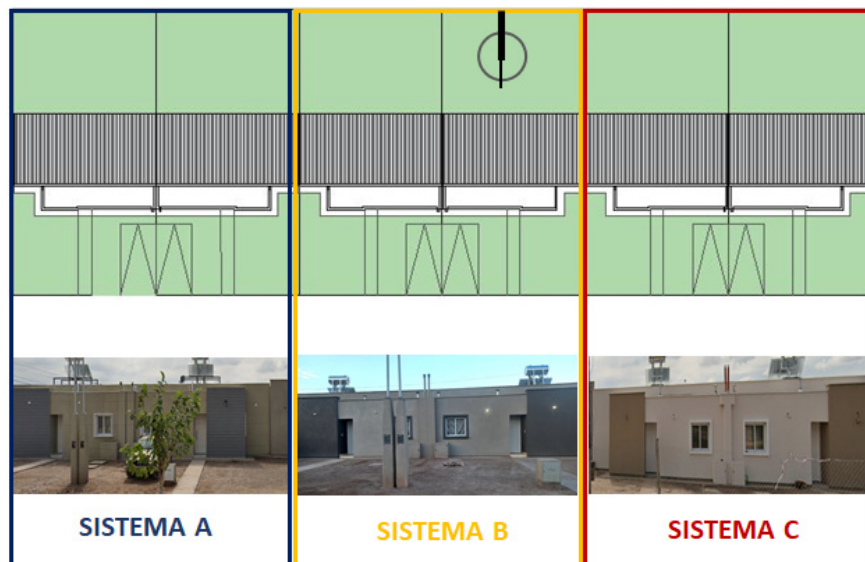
Planimetría y fachadas de las viviendas en estudio, Guaymallén, Mendoza (fuente: elaboración propia, 2023).
